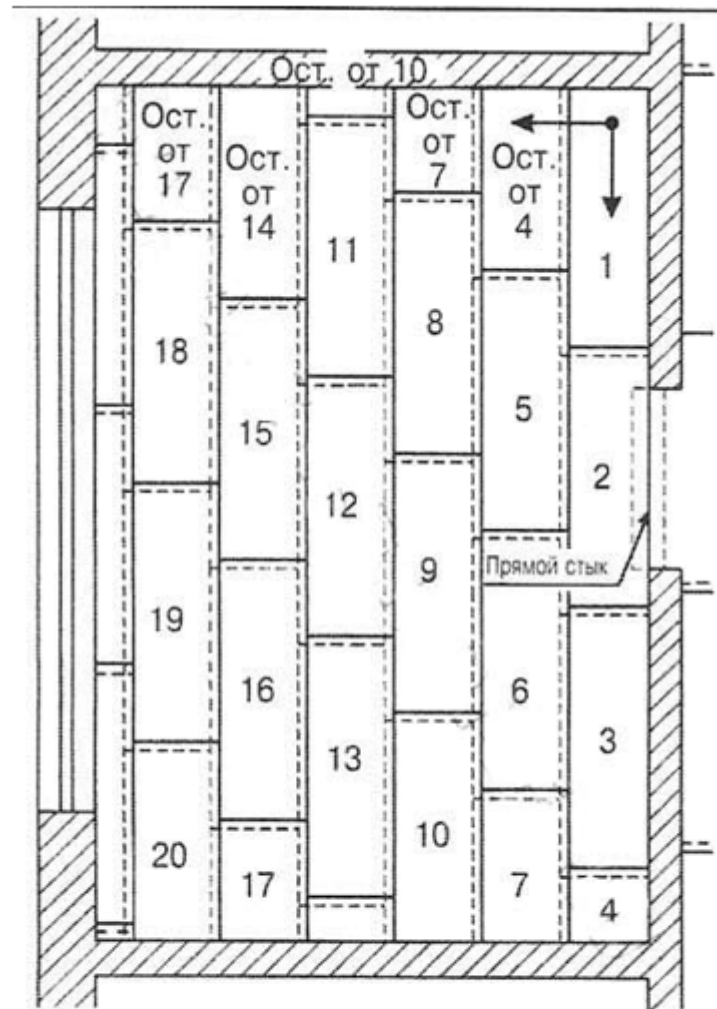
Укладка сборного основания из элементов пола ОП 131 от стены с дверным проемом
